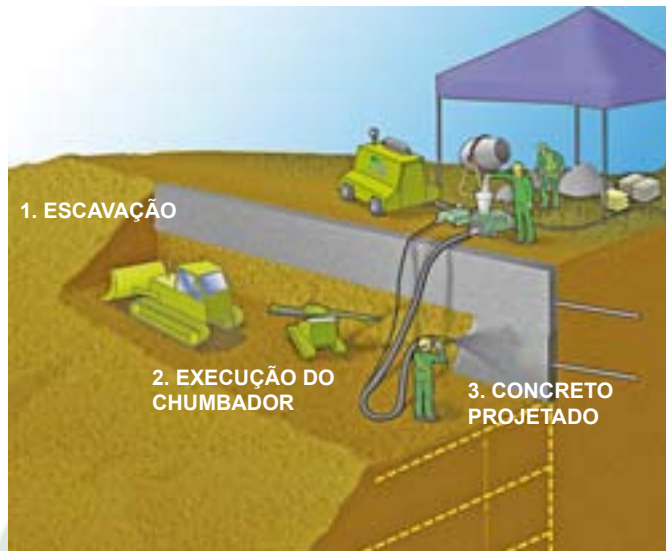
Fases construtivas em corte. Exemplo de escavação mecanizada
